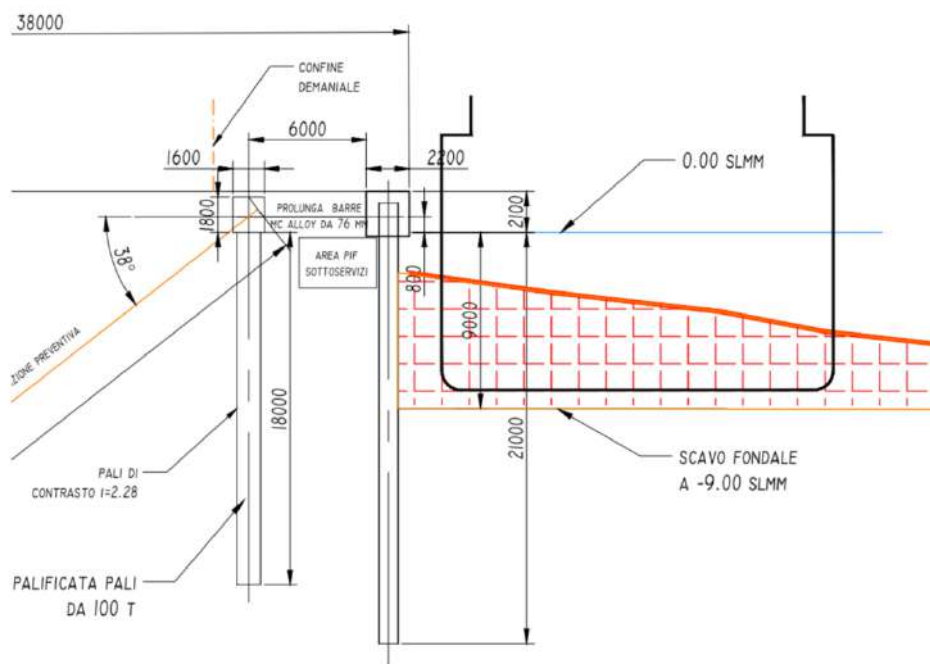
sezione di progetto oggetto di modifica dell'ATF
